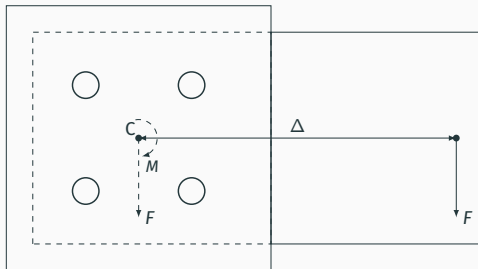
Ligação com pré-esforço e carregamento excêntrico no plano da ligação [2].
